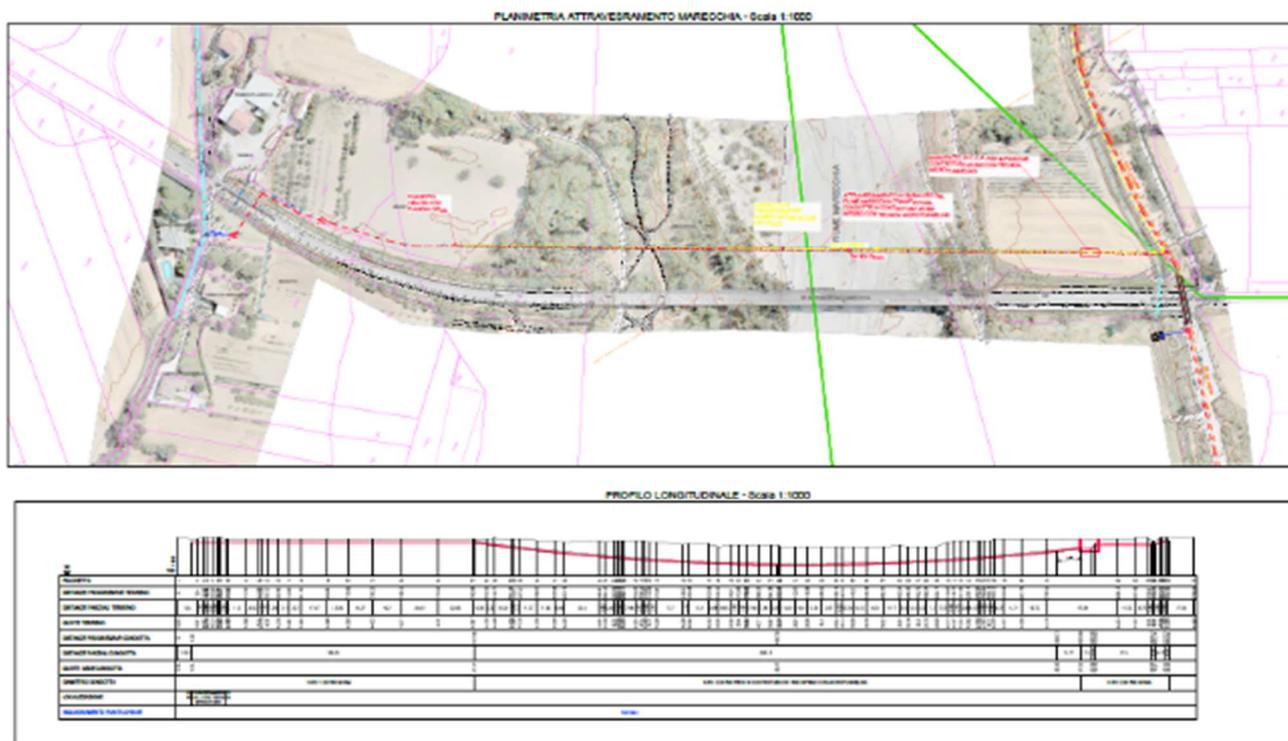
Planimetria e profilo delle condotte di attraversamento del fiume Marecchia (tav. B.6.1)
